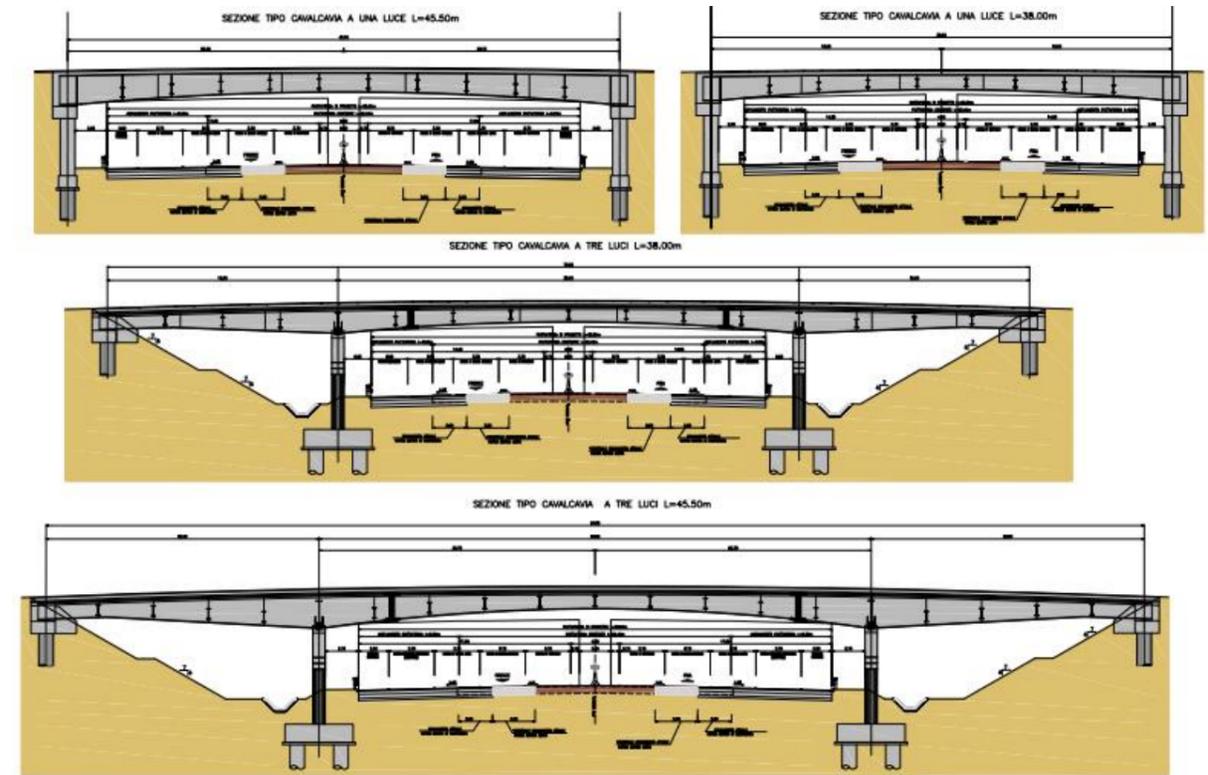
Sezione tipo in corrispondenza di nuovi cavalcavia.
